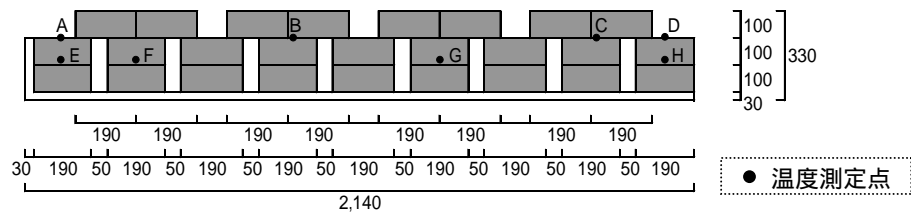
(b) 蓄熱体断面図（X-X 断面）（コンクリートブロック）
